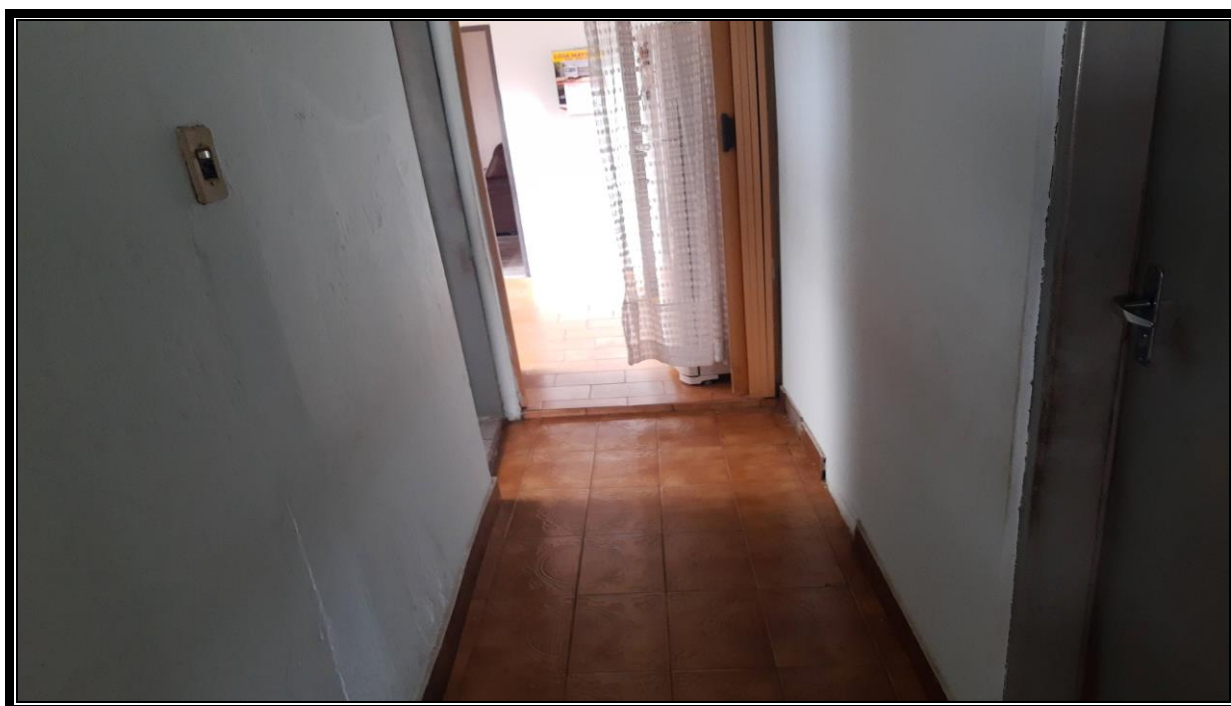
Vista interna da casa residencial, onde ilustramos o piso em cerâmica, com acabamento das paredes em argamassa e em tinta látex.
